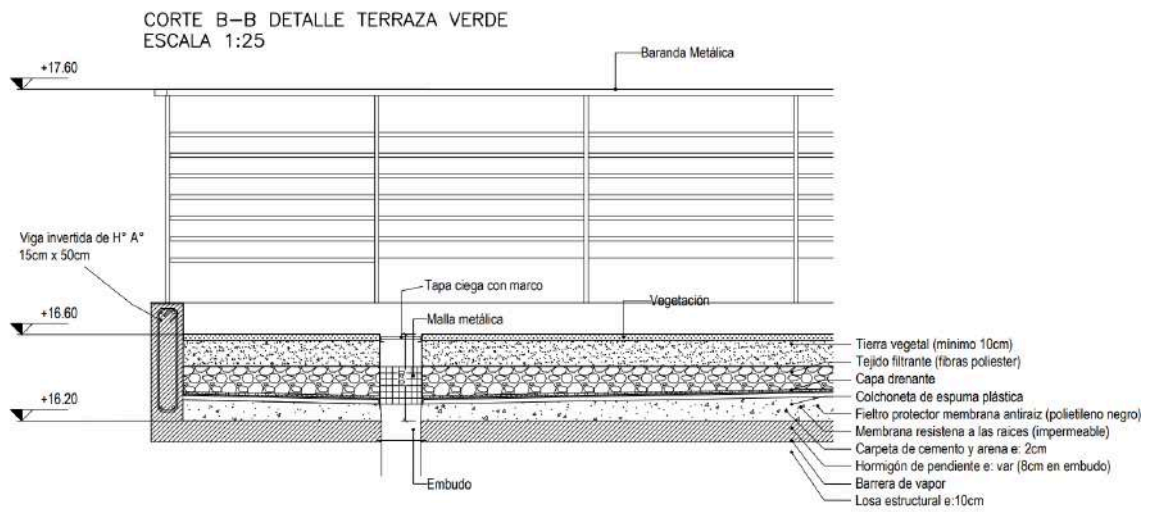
Detalle constructivo terraza verde - Plano A12- Producción propia
